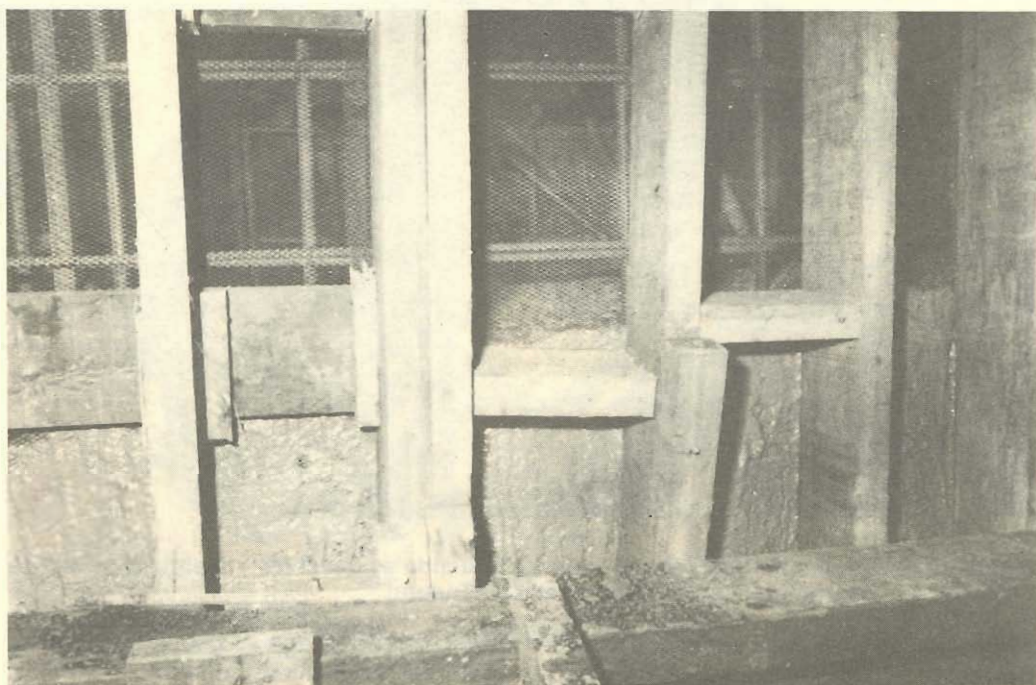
Aplicação de forma de tela de metal expandido. Observa-se o embebimento da tela pelo concreto-Itaipu
